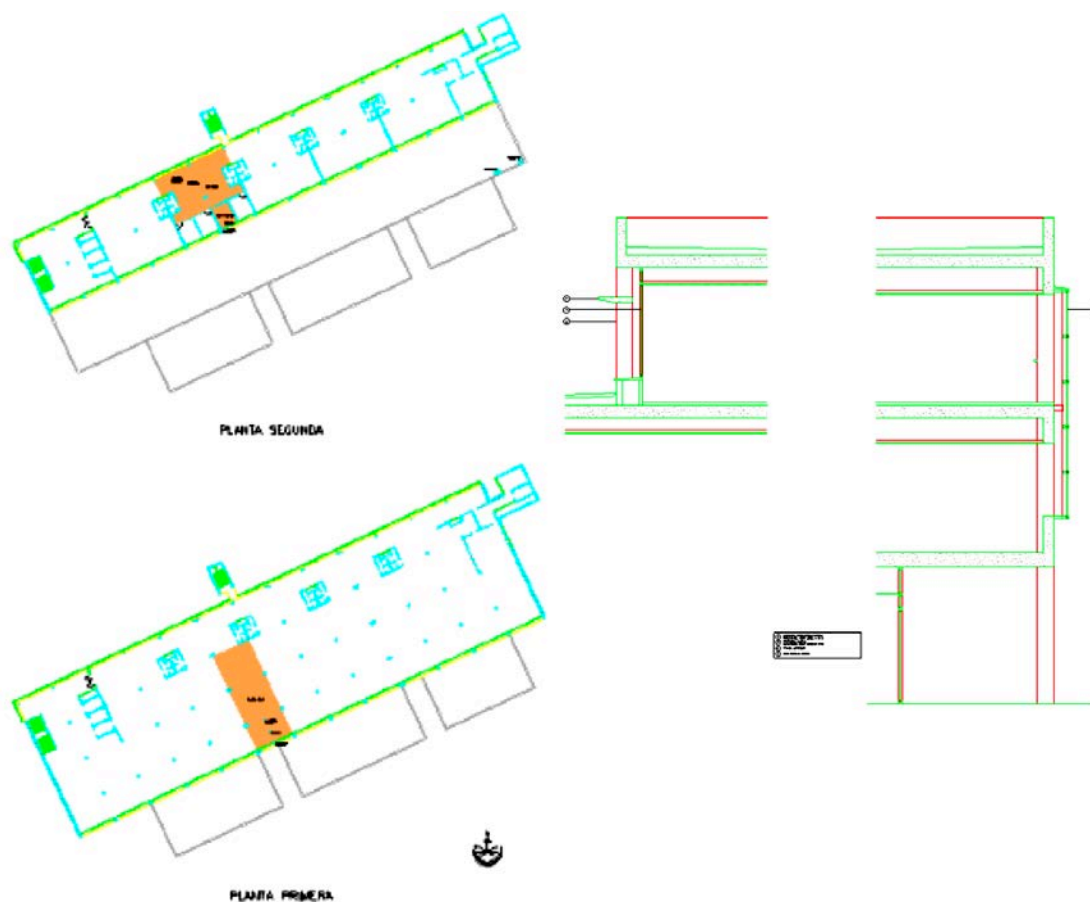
Modelos CAD de planta tipo y sección de solución de fachada para Centre de Serveis. Fuente: ALIA y Elaboración propia.
